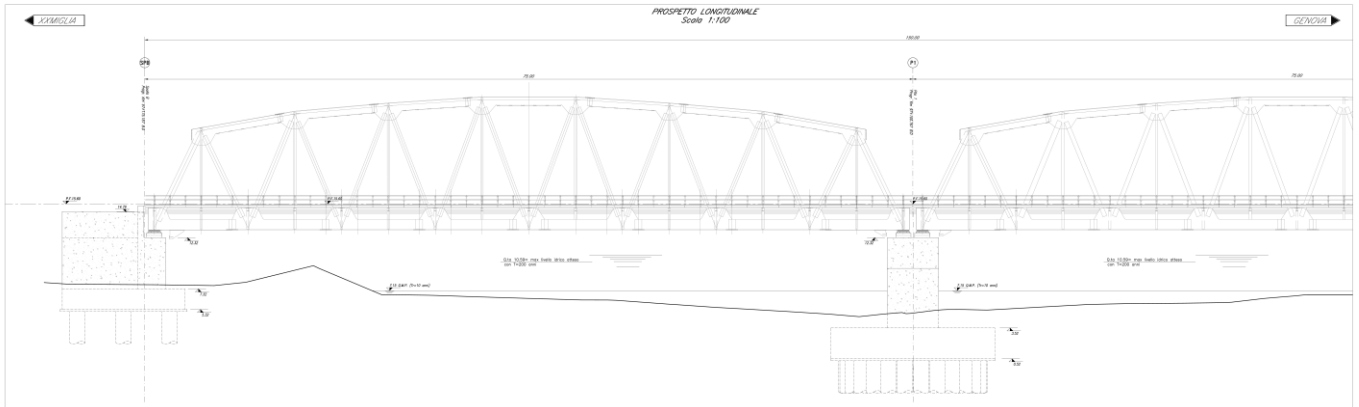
Prospetto longitudinale della travata metallica a doppio binario L=75.00m.
